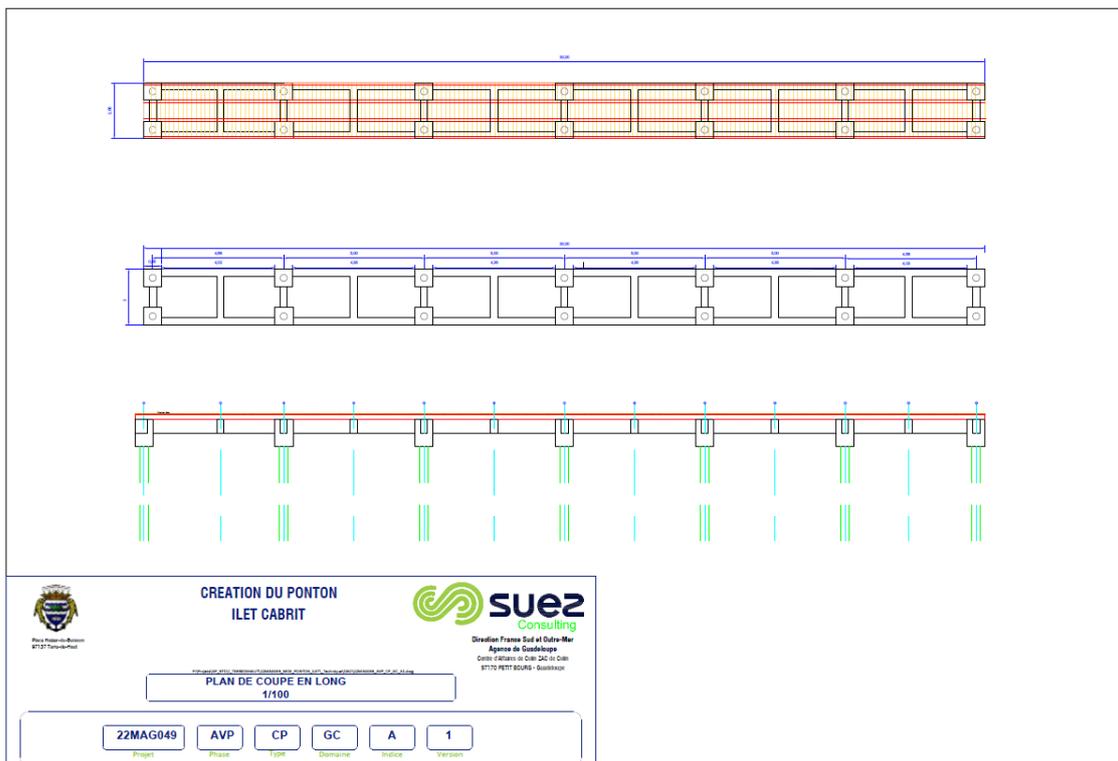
Coupe longitudinale du ponton (source : AVP Suez Consulting, novembre 2023)
